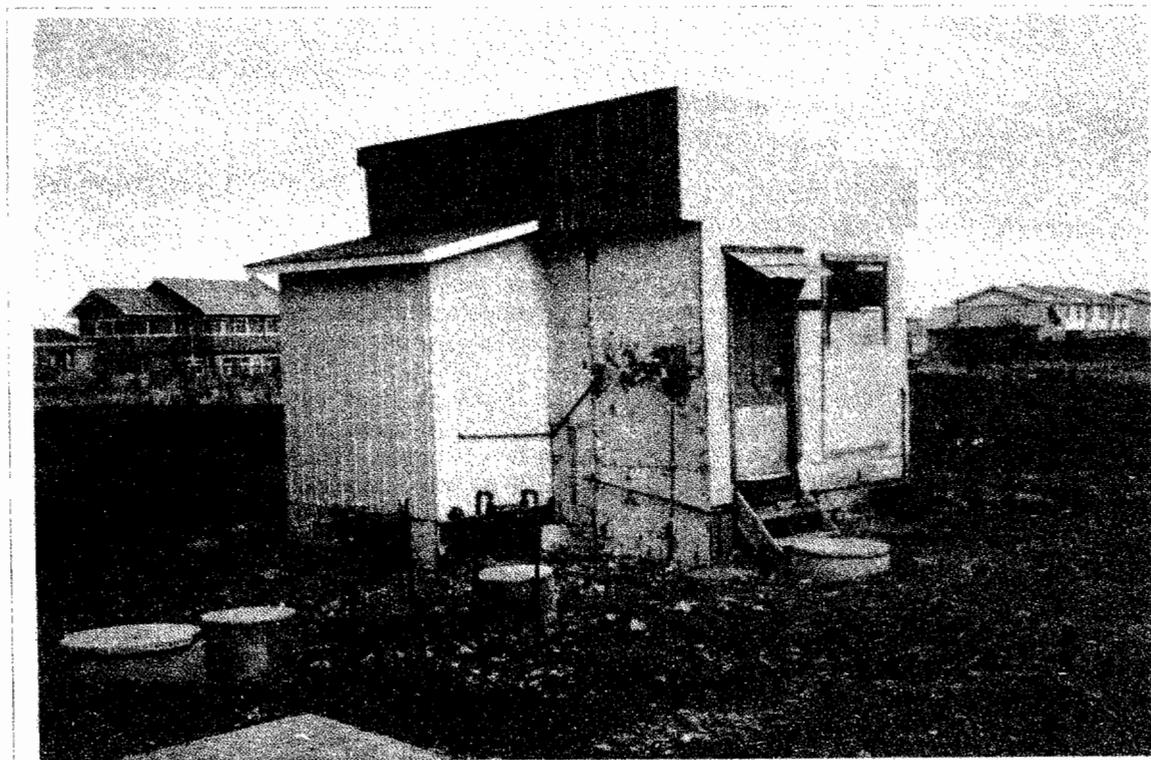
Caseta sanitaria en sistema constructivo en madera revestido con zinc. XII Región.
